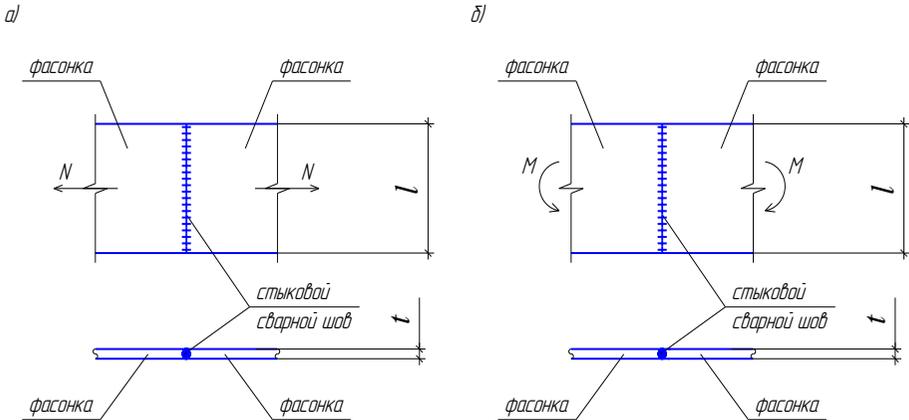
Схемы соединений, образованных стыковыми сварными швами:
